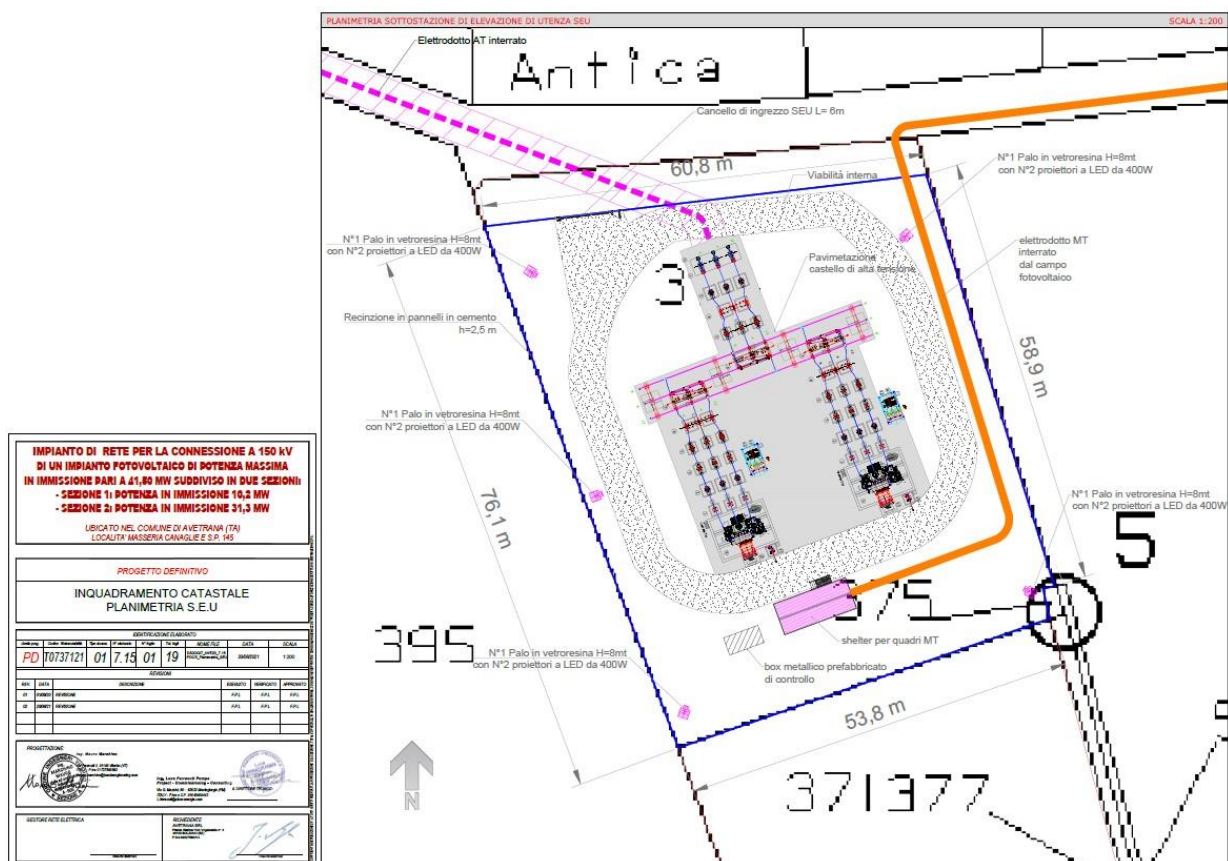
Nuova S.E.U. (Stazione di Elevazione di Utenza) – Schema Planimetrico.
